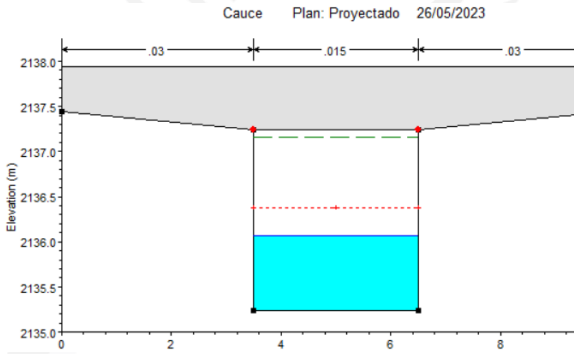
Sección 61, Box Culvert N°2- (Aguas arriba)- Abscisa 0+156.82
